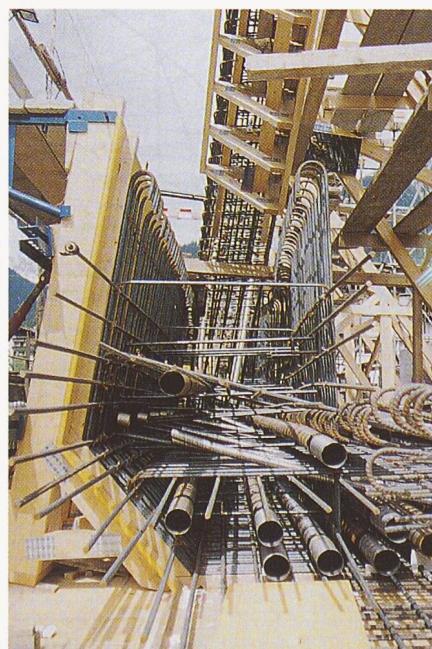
Zugstrebe mit 2'600 kN-Kabeln links, Druckstrebe mit Gewindestäben rechts (Foto: W. Maag)
